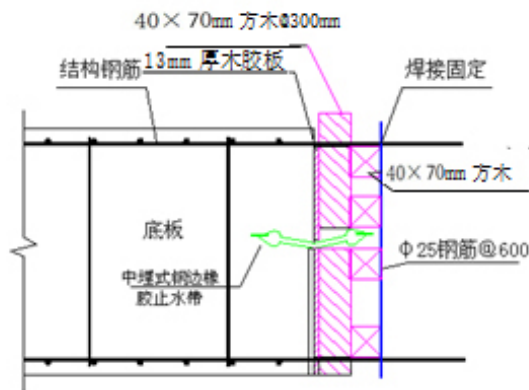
底板施工缝端头模板及支撑体系剖面图
